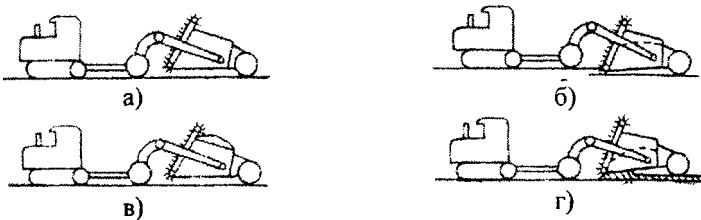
Рабочий цикл скрепера с принудительной загрузкой: а - порожний ход; б - загрузка; в- груженный ход; г- разгрузка
